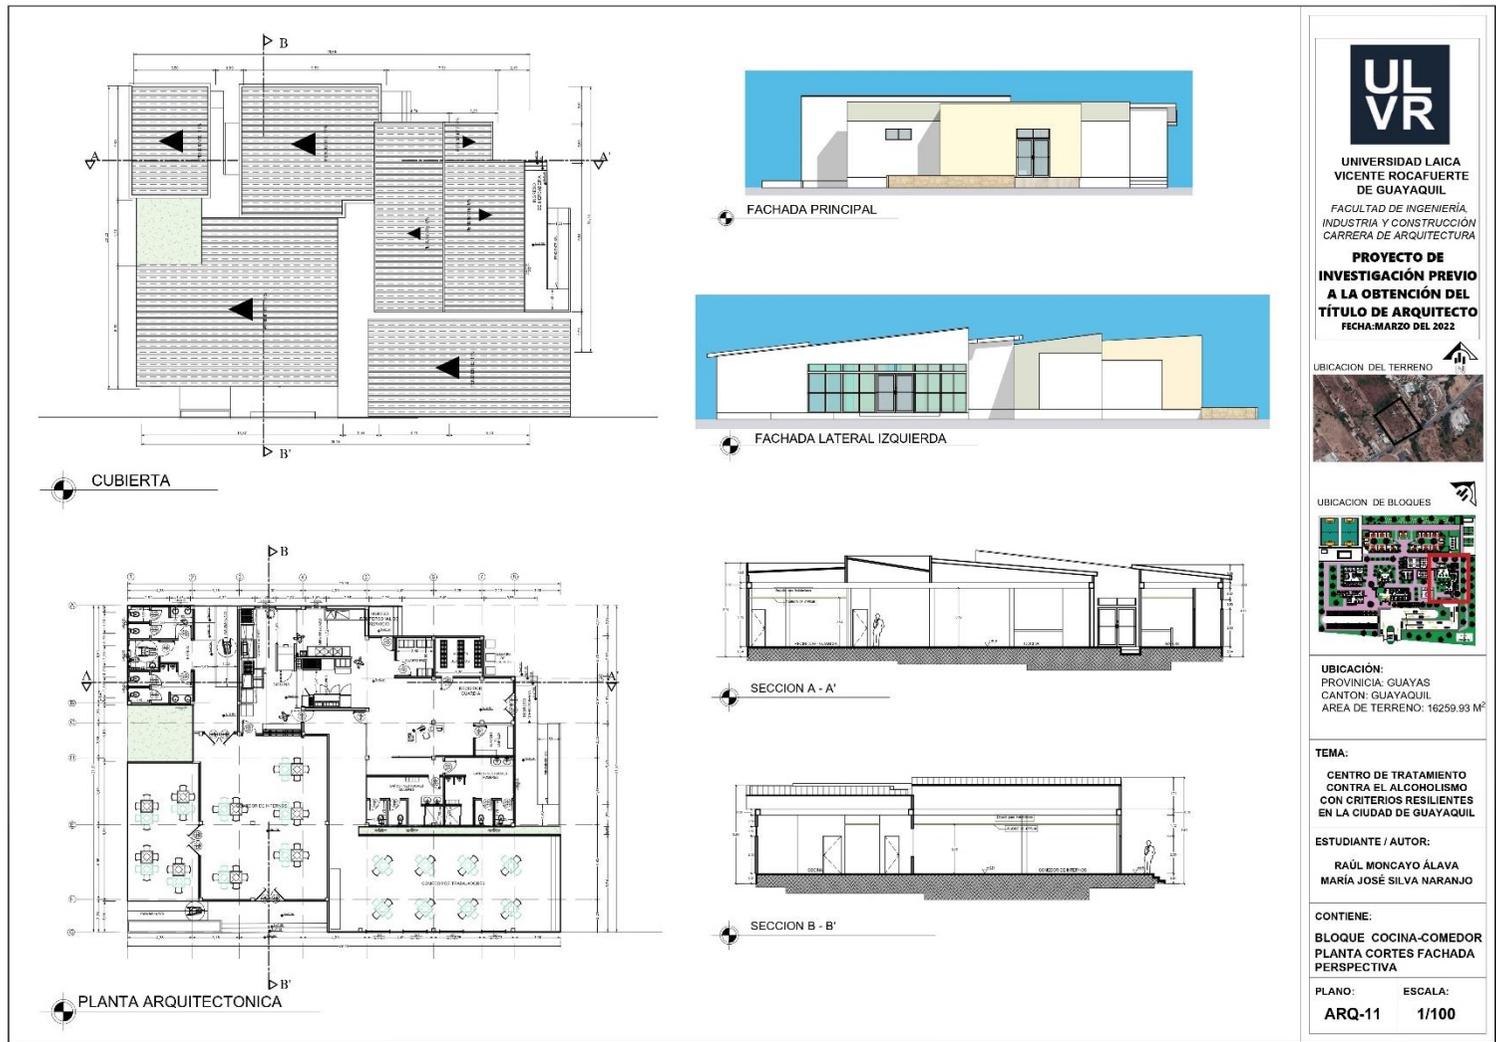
Cocina-Comedor. Planta cortes fachada perspectiva.
